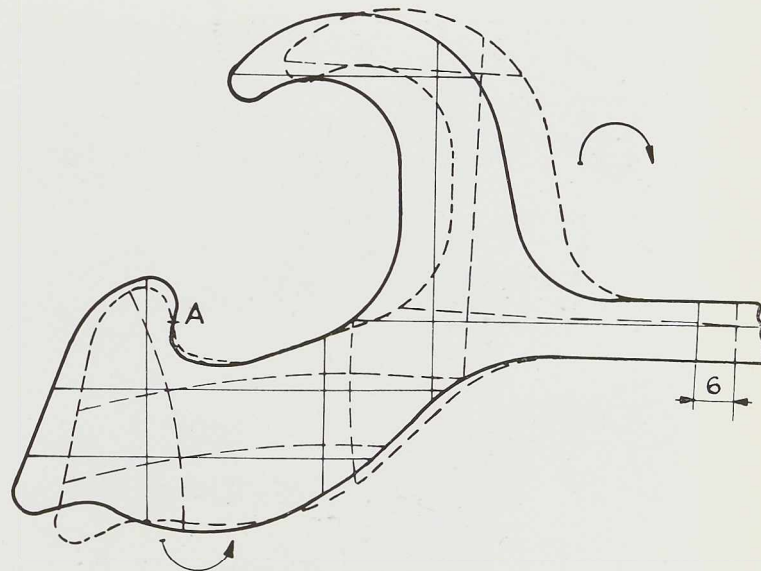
Comparaison de la forme des crochets des palplanches en acier laminé, avant essai et à l'instant avant la rupture à 16 400 kg (voir fig. 150).
